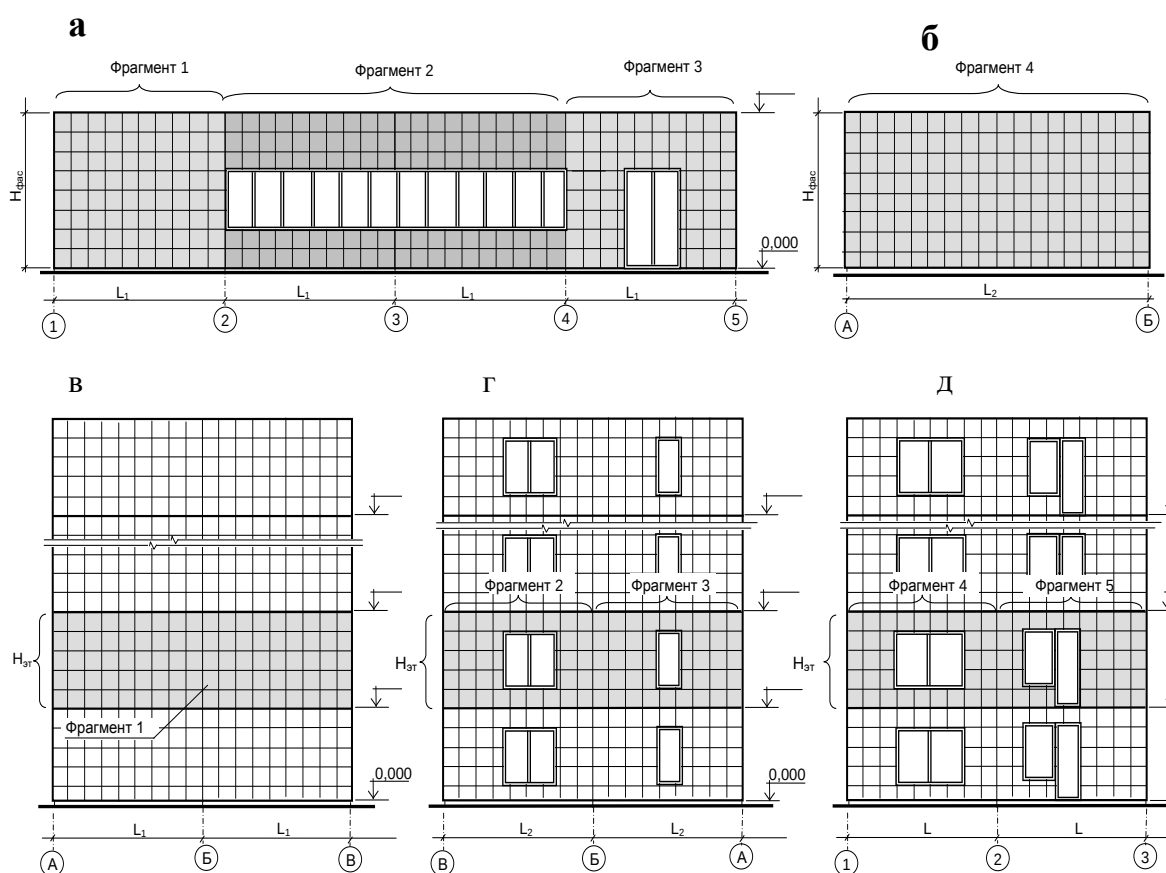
Примеры разбиения фасада здания (а, б) или промежуточного этажа (в, г, д) на отдельные фрагменты для расчета приведенного сопротивления теплопередаче по формулам (27), (28)
